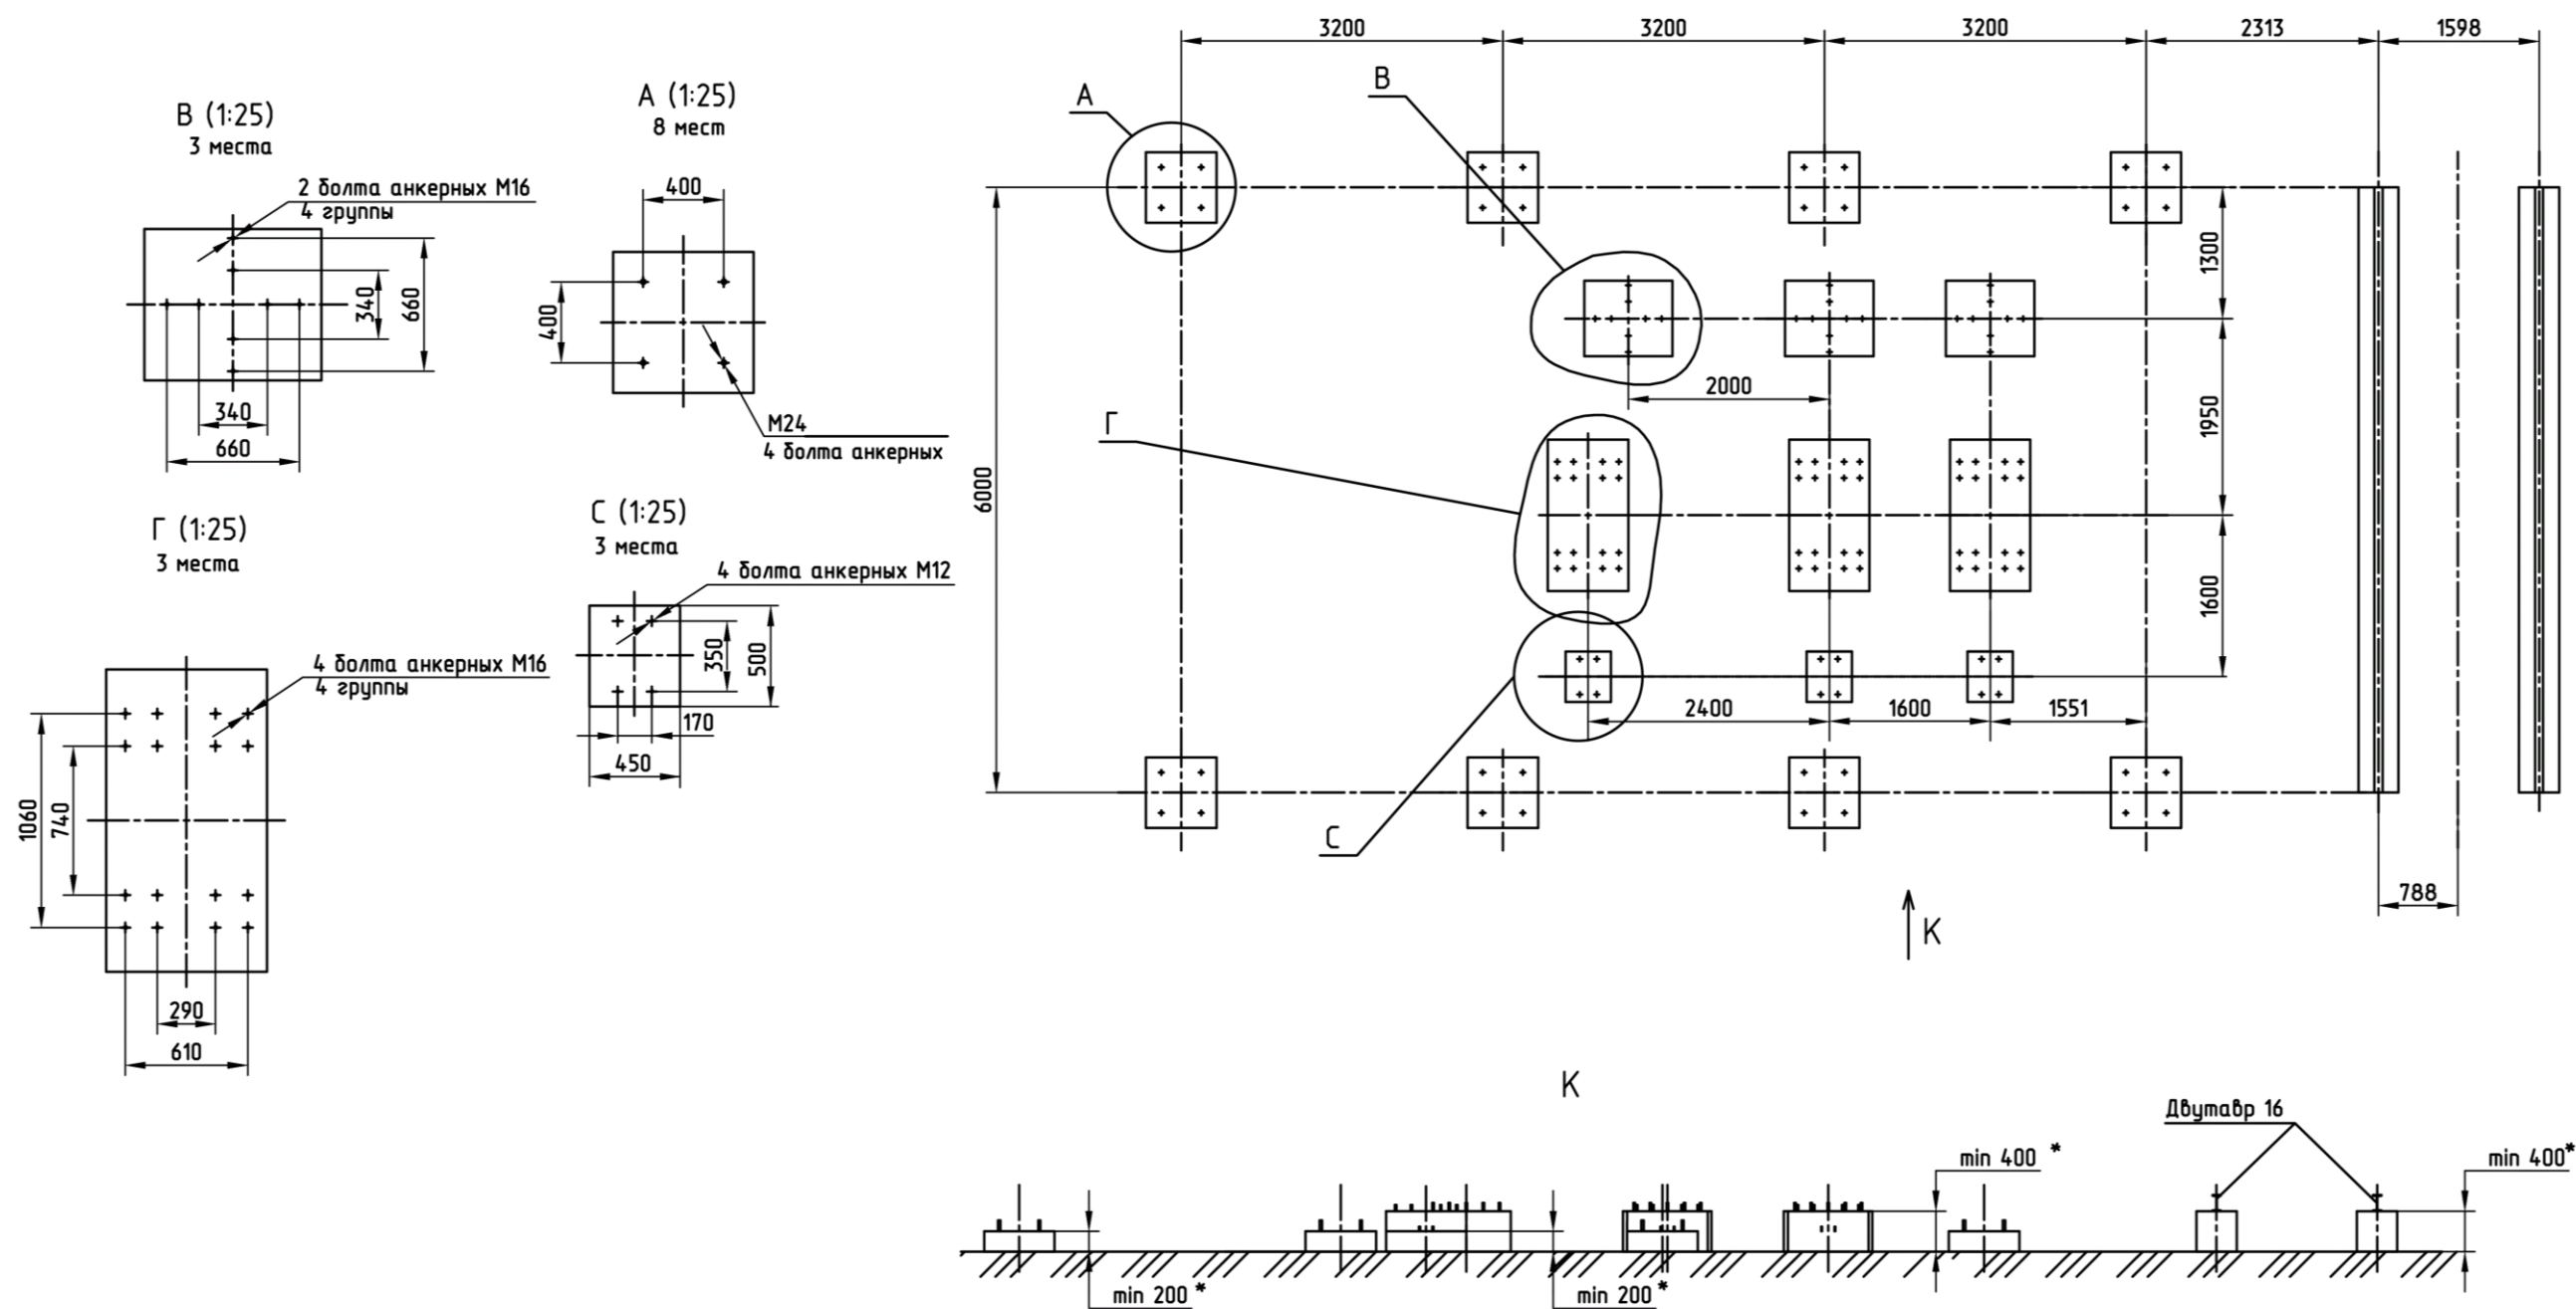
План фундамента для УПК-У-25 кВ-2400 А У1
